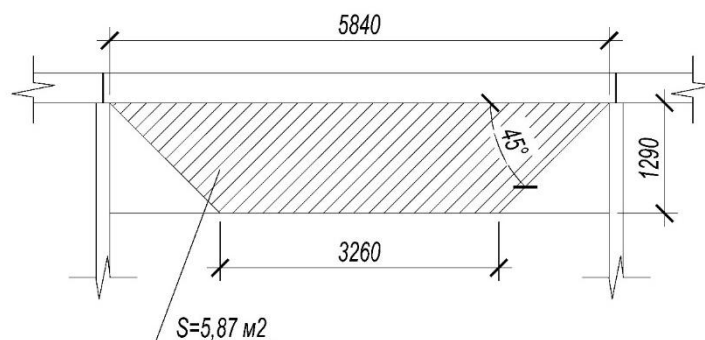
Грузовая площадь от перекрытий и покрытия
